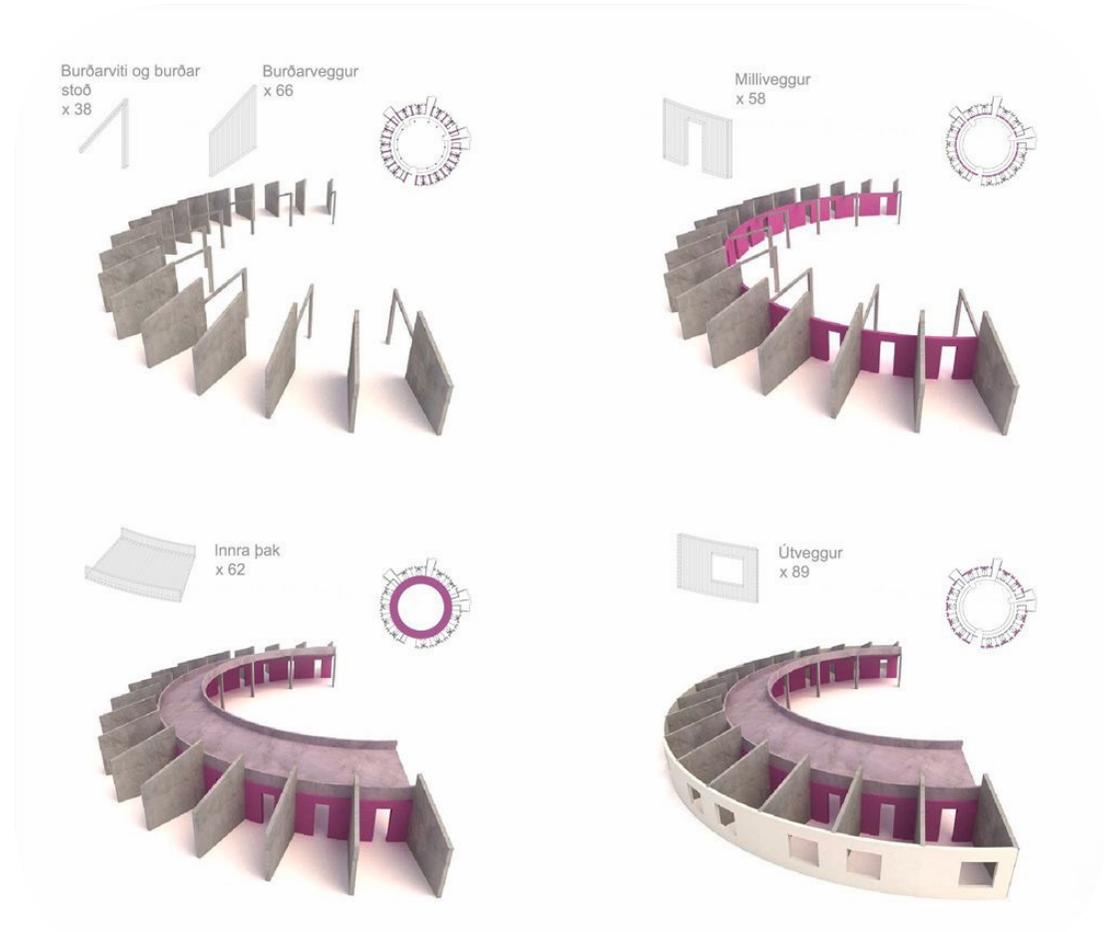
Cantidad de paneles prefabricados para la construcción del centro
